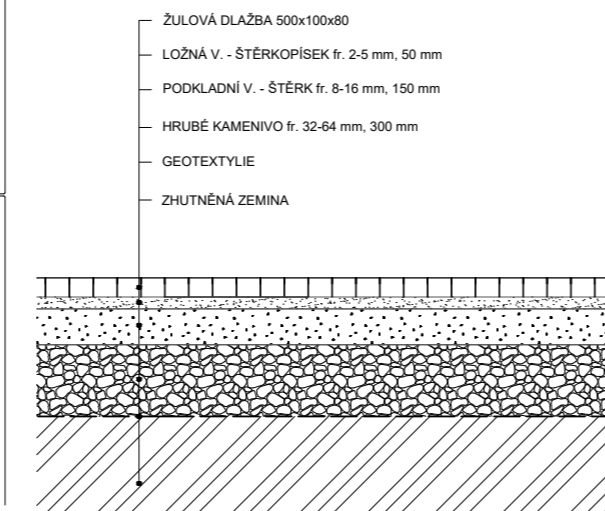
DETAIL STYKU DLAŽDĚNÍ, SKLADBA S01.1 PŮDORYS 1:5
